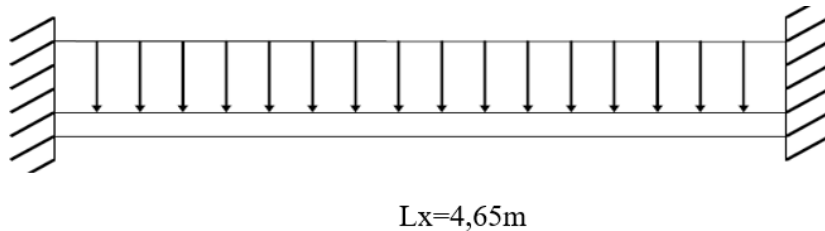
3: schéma statique de la poutrelle-Encastée.
